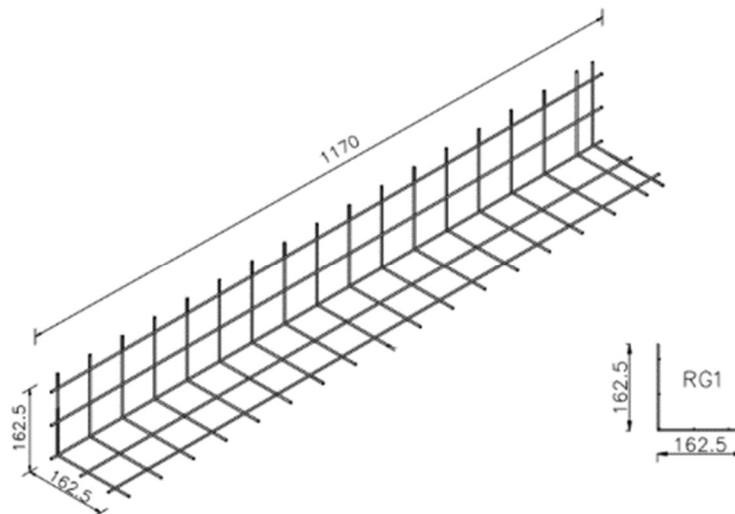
Malla de refuerzo tipo RG1 - Emmedue, 2008.
